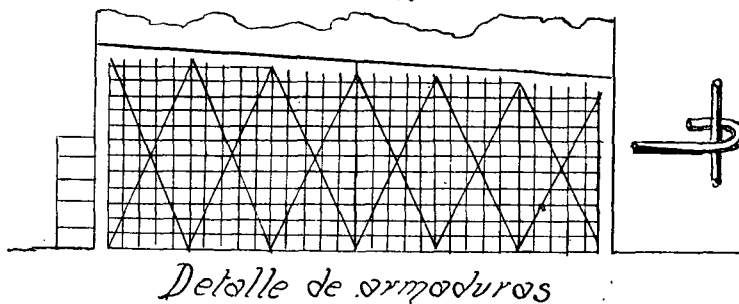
Alzado y detalle de armaduras de un abrigo.
